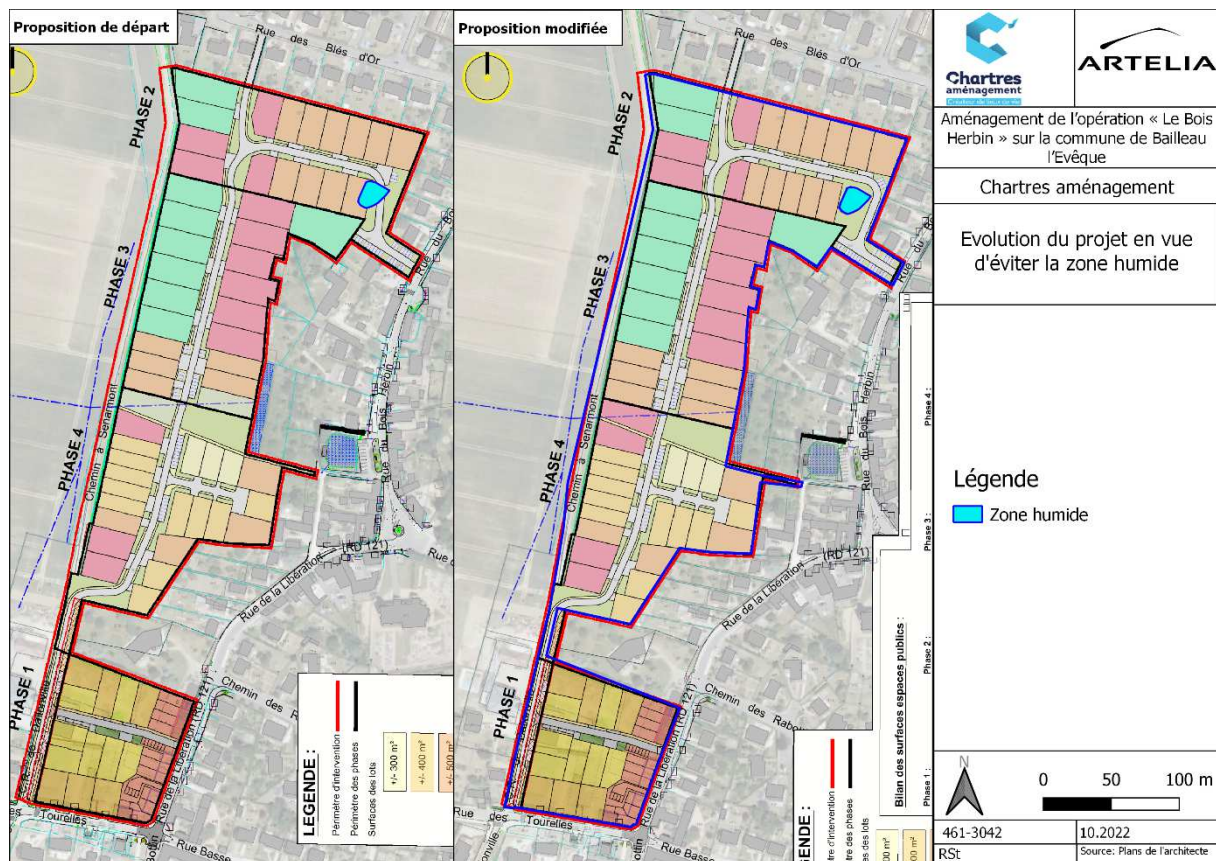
Evolution des plans projets suite à la délimitation de la zone humide sur le site - Plans de l'architecte
